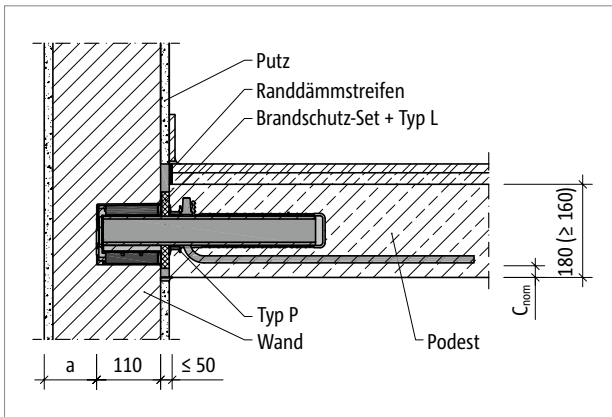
Schöck Tronsole® Typ P: Brandschutzausführung
